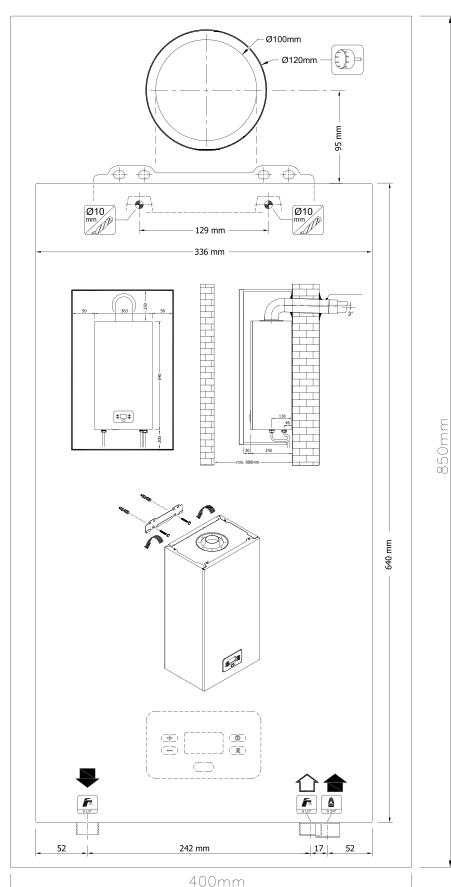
Plantilla de montaje de Aquwa 12
